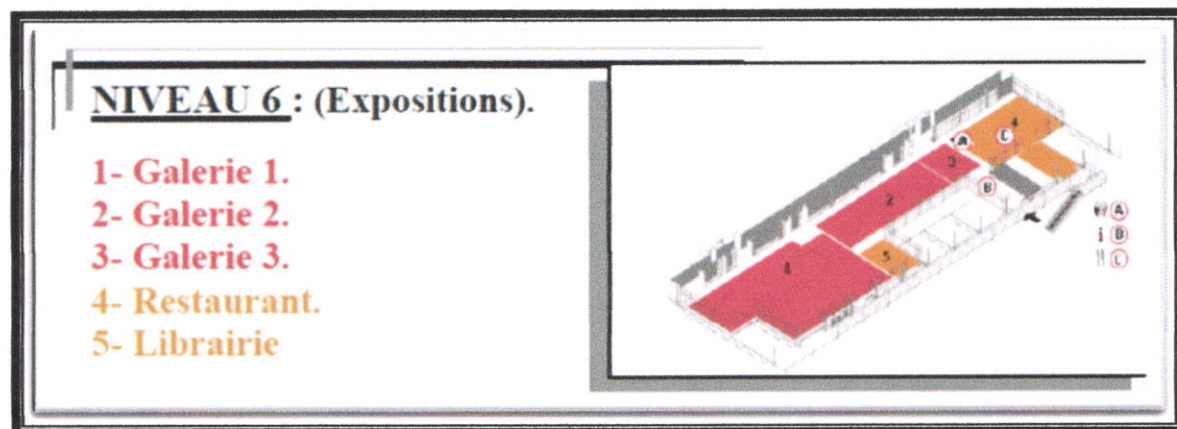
PLAN DE NIVEAU 6 (CENTRE POMPIDOU)
